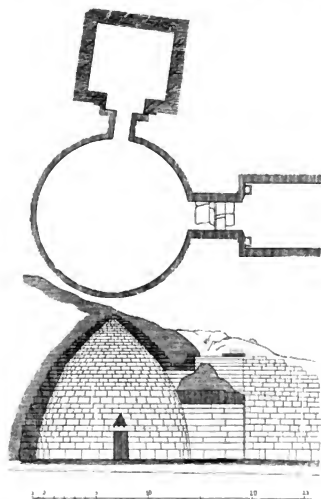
Kuppelgrab zu Mykenä. Grundriss und Längsschnitt.
